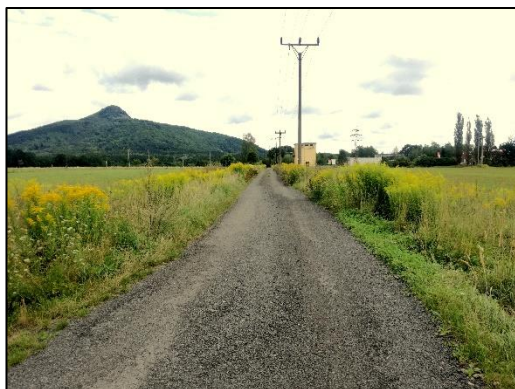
Polní cesta DC3 se zamokřeným územím
